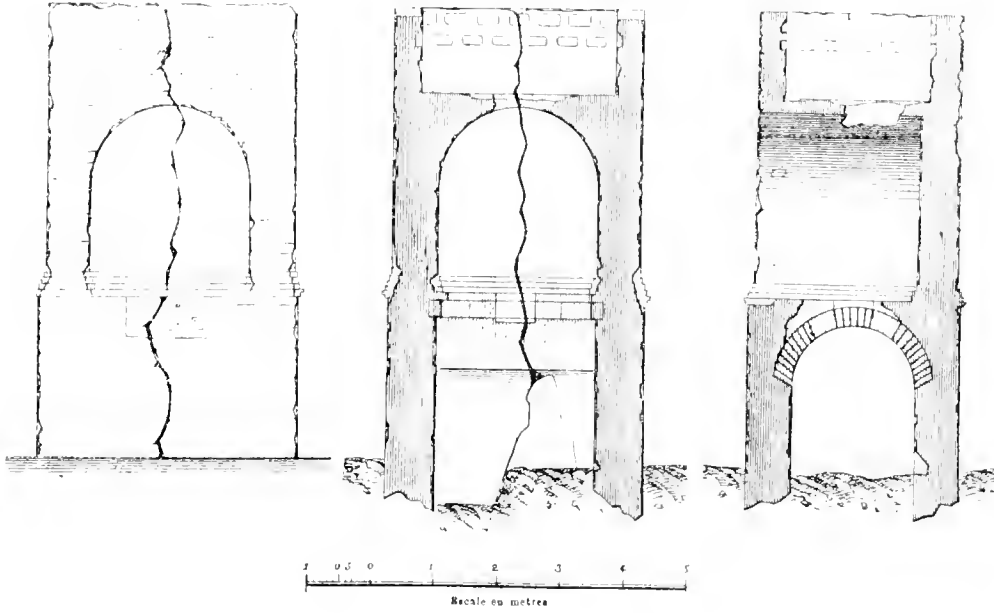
Sepulchre de Vilablareix — Plans, fatxada y seccions (Girbal)
